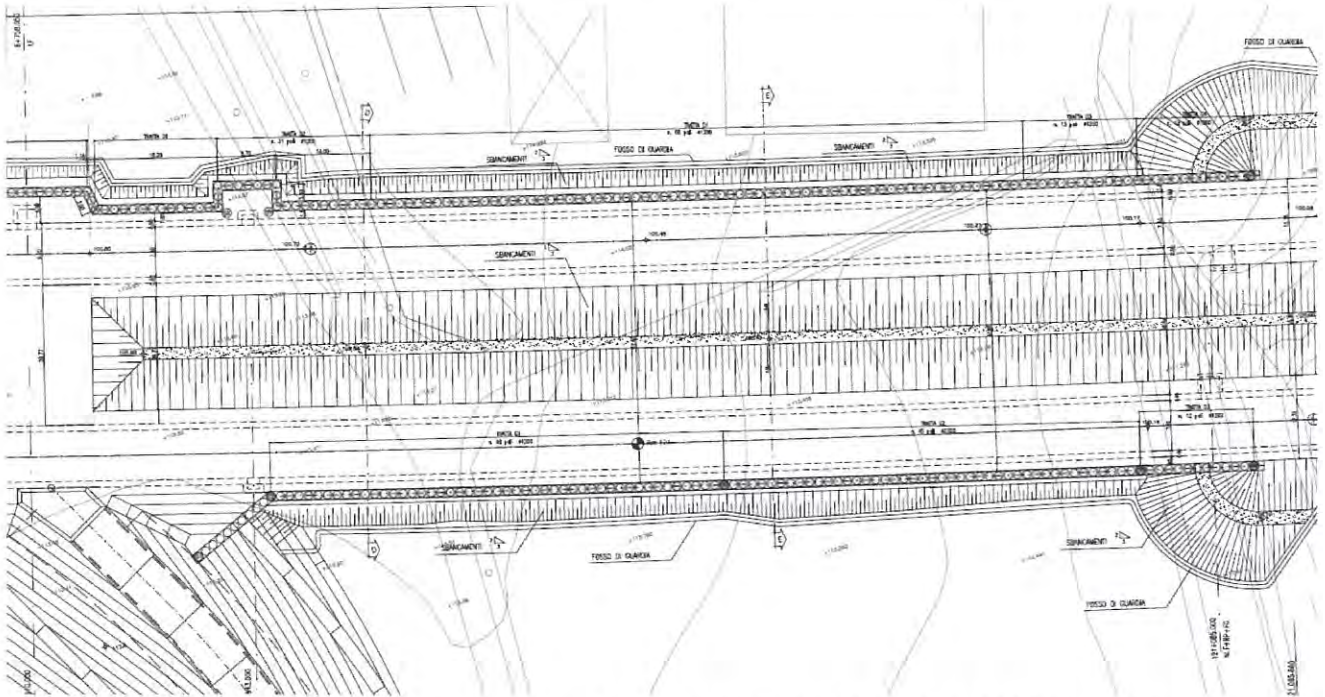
Planimetria di scavo delle opere provvisorie in corrispondenza dell'azienda Serraglio
